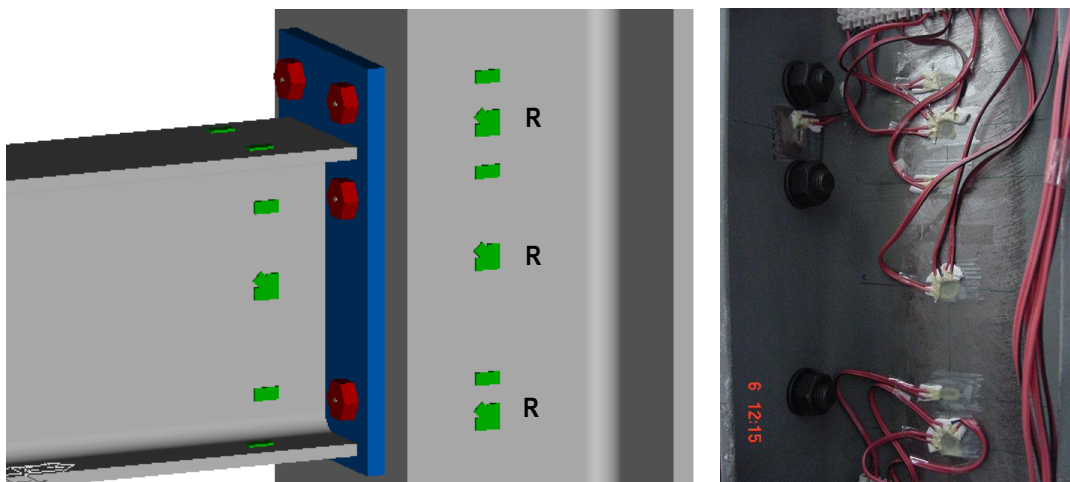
Posicionamento de extensômetros e rosetas na alma da viga da coluna
